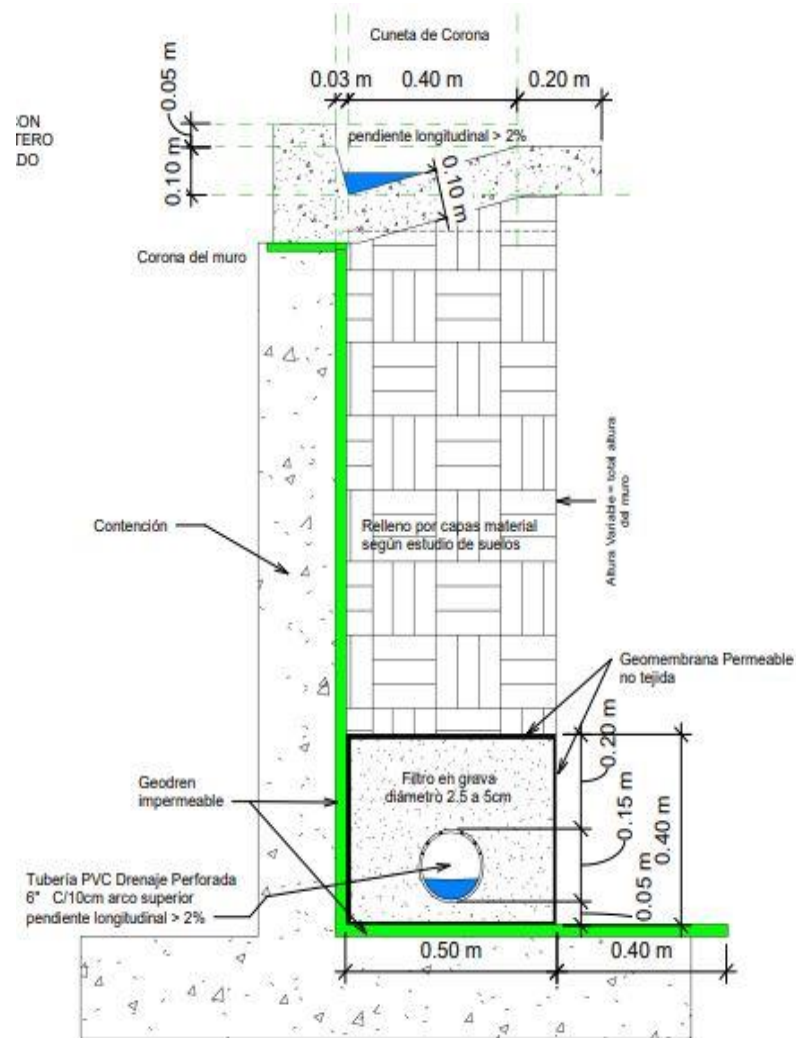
Instalación Capa Impermeable de Polietileno.
